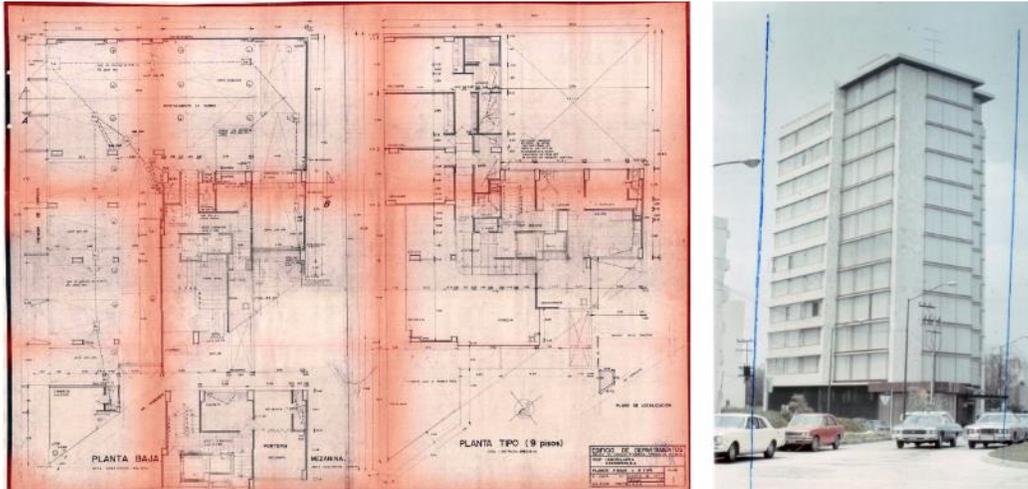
Plano planta baja y tipo, enero 1971, y vista de la fachada del edificio ubicado en Horacio núm.1834. En la fotografía se observan un par de líneas que señalan que están giradas las verticales de la foto, ca.1973
